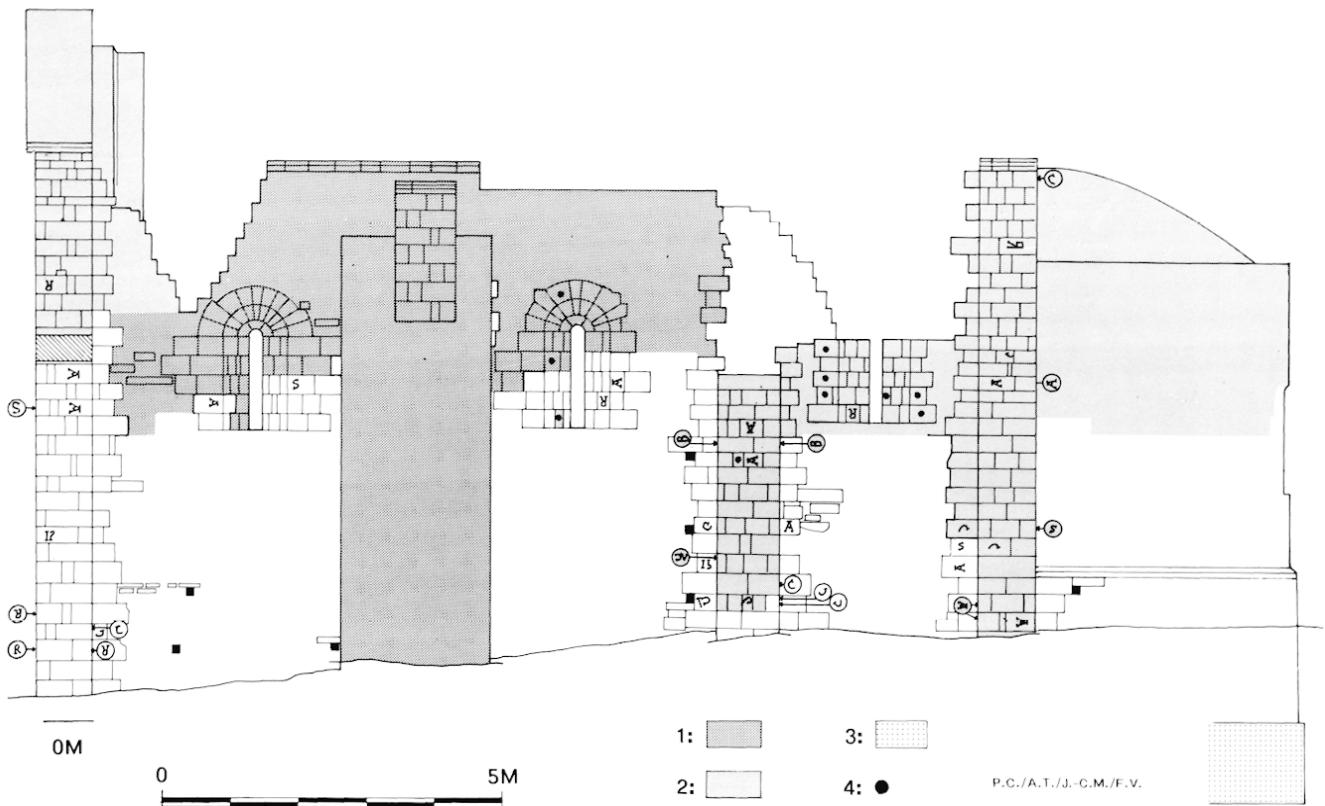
Elévation externe du mur goutterot sud. 1 - Restaurations, adjonctions anciennes. 2 - Restaurations de 1946-53. 3 - Fondations, 4 - Moellons enduits de lait de chaux.
